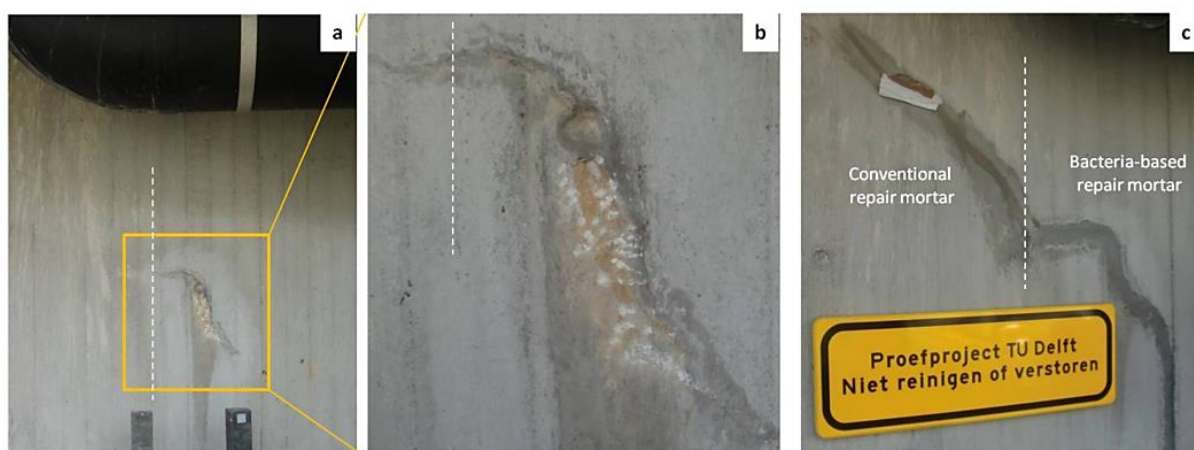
Fissura na estação de tratamento de água antes da reparação: (a), (b) e (c) após a reparação com argamassa autorregenerante e com argamassa convencional [52]
